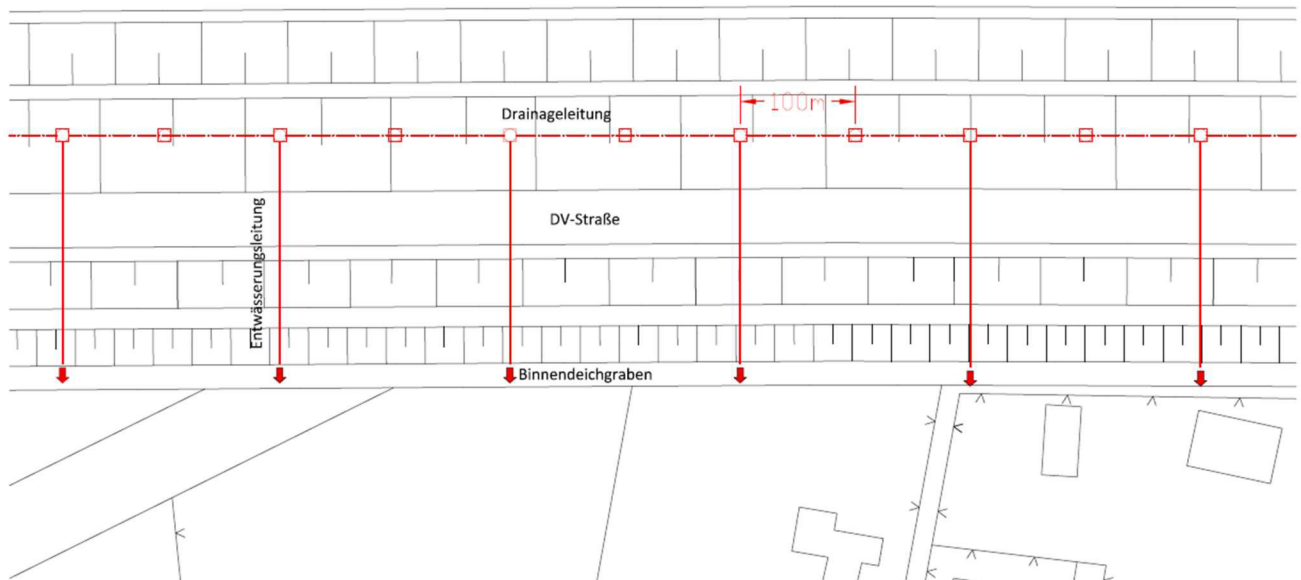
Deichkernentwässerung zur Binnenseite, Drainageleitung mit Schächten und Entwässerungsleitung, schematischer Lageplan
